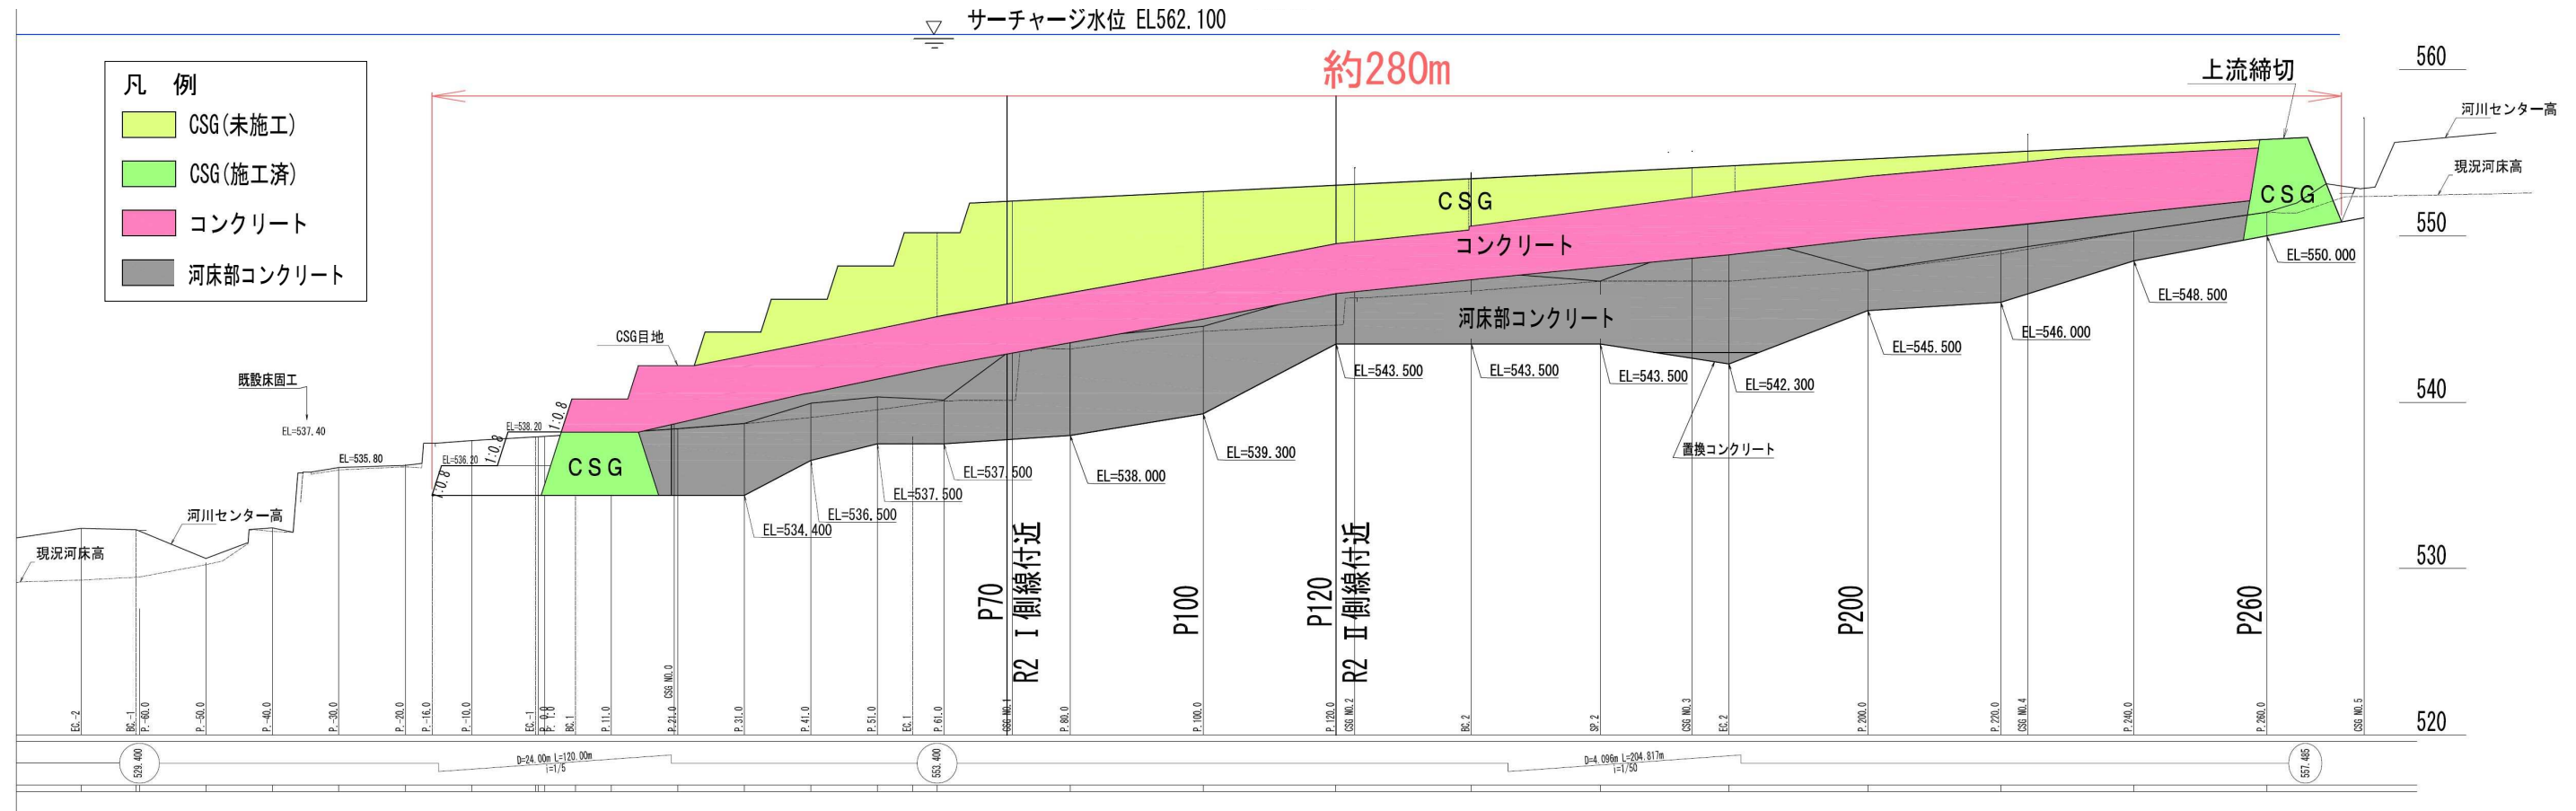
河床部コンクリートおよびCSG 施工実績図
